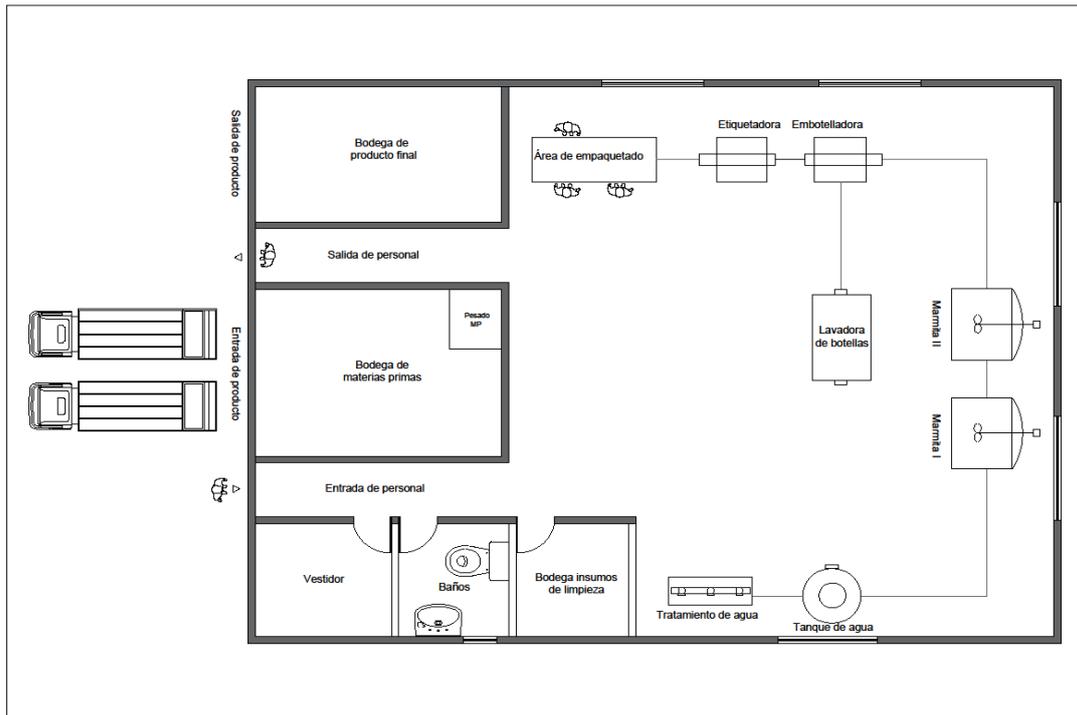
Distribución de la planta de elaboración de Licores (Planta Baja).
